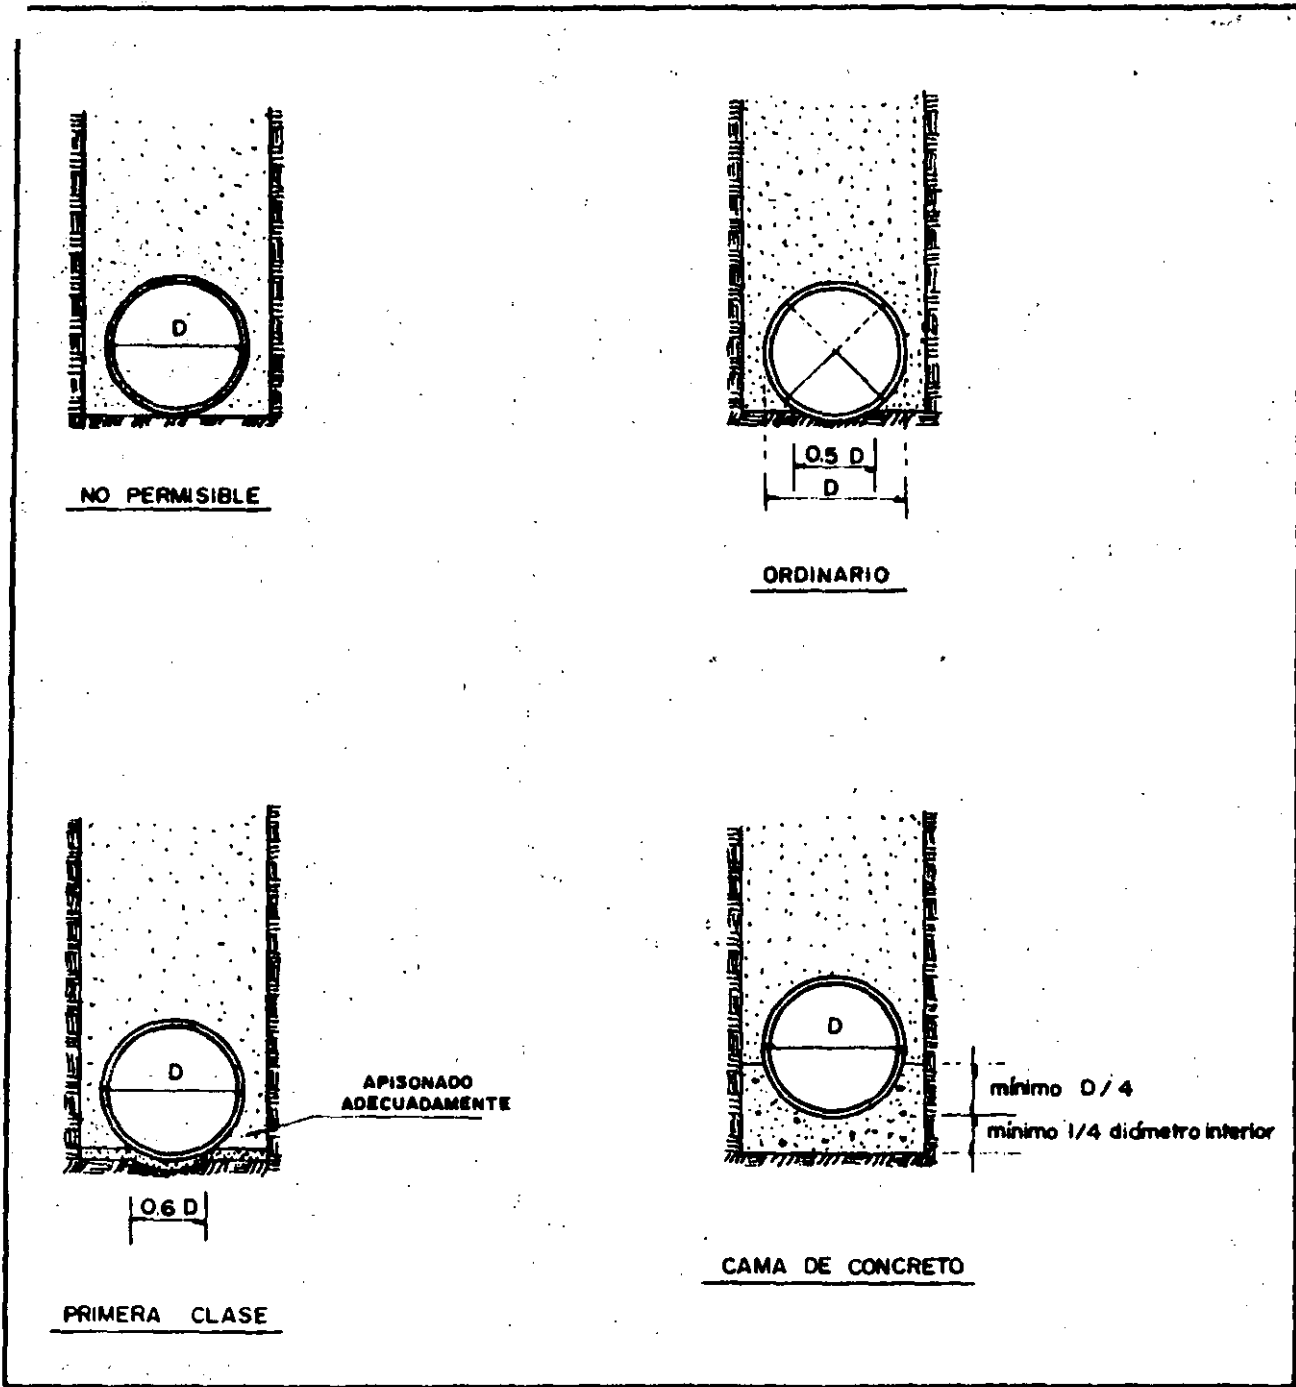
Tipos de camas para tuberías en zanjas
